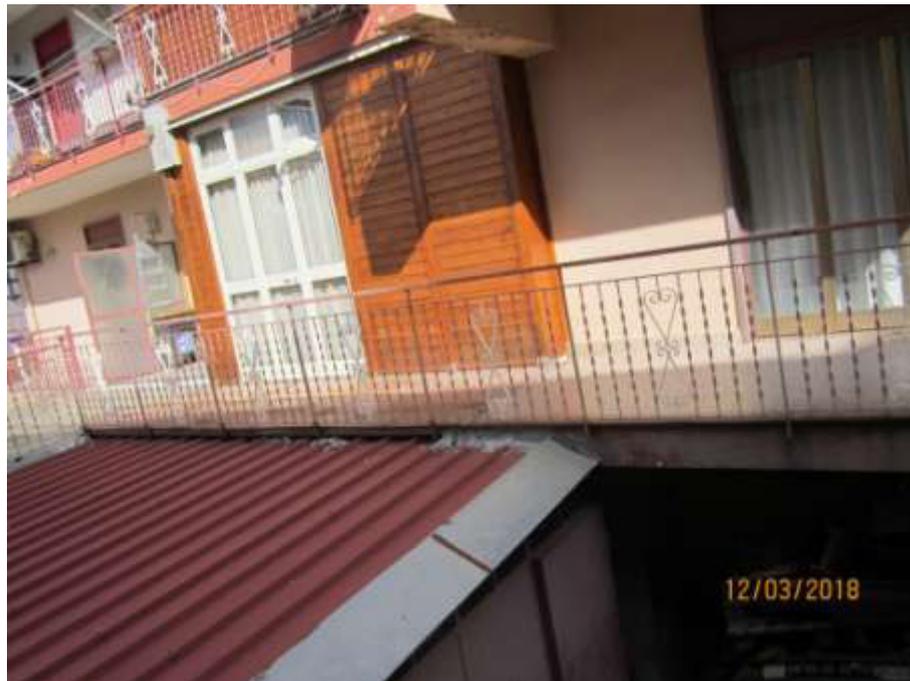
Prospetto lato sud, vista della parziale copertura del balcone che chiude la scala di collegamento col piano superiore
